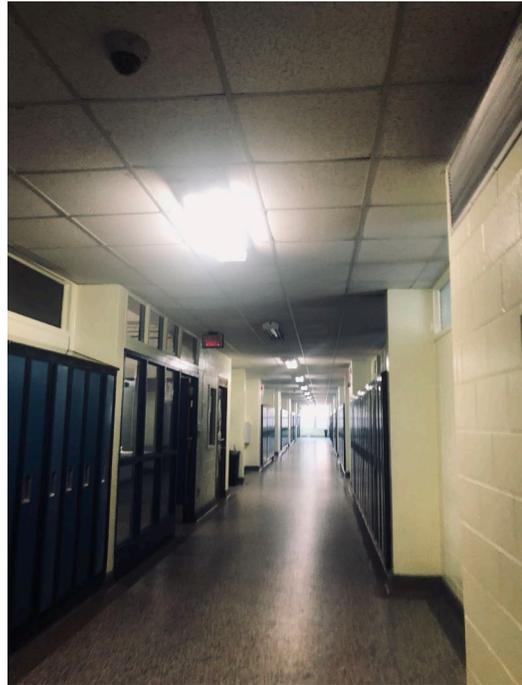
Plafond suspendu 2x2 corridor1 rdc
